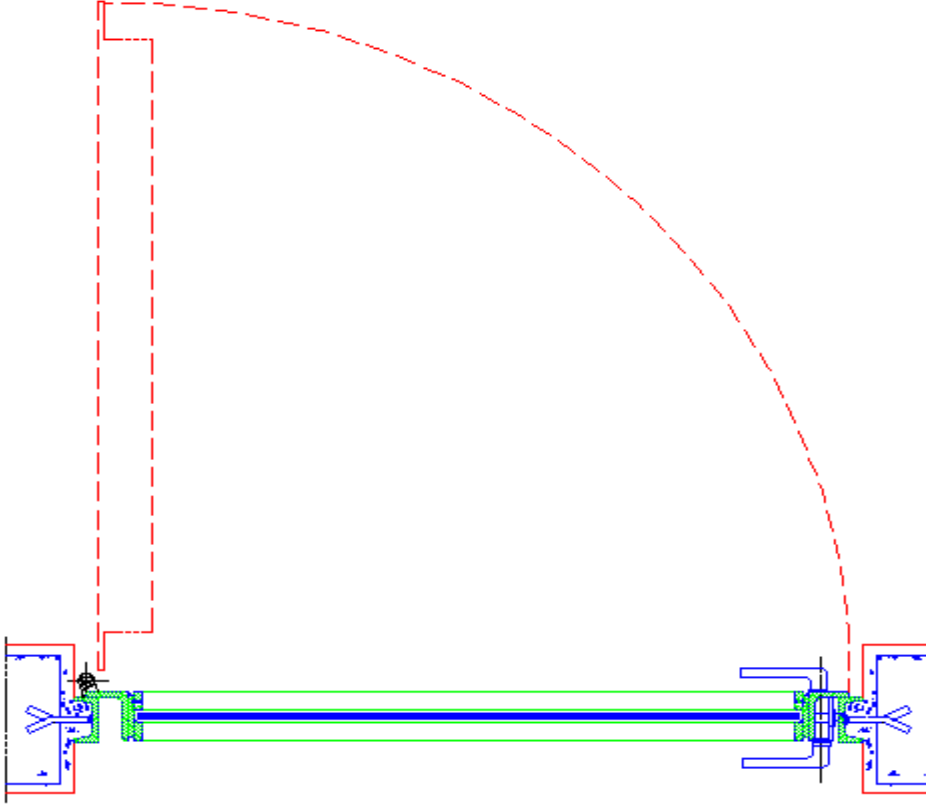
Çelik kapı planında duvar boşluğu ve kapı kasasının çizimi
